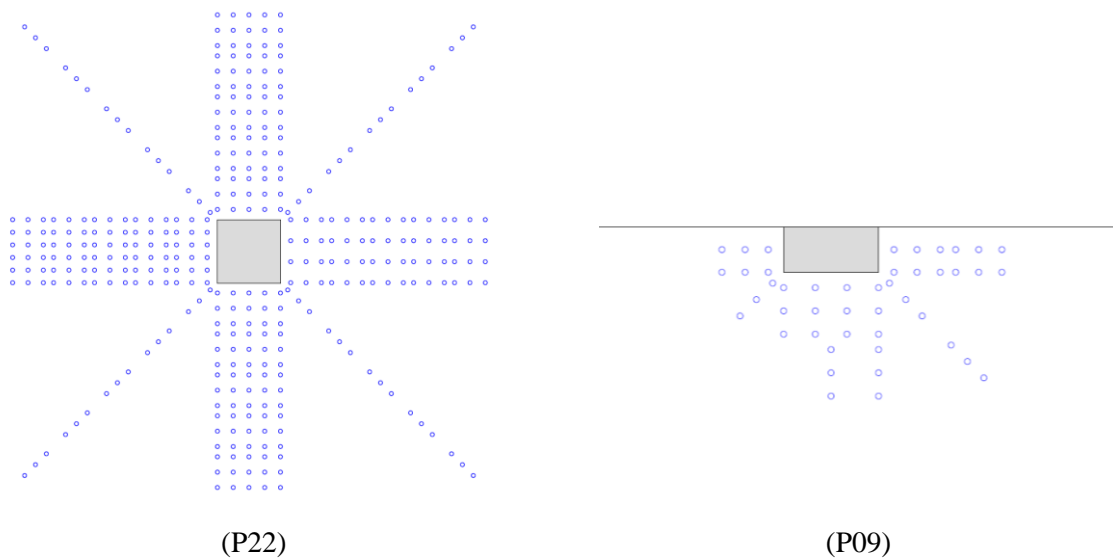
Detalhes das armaduras de cisalhamento do tipo stud
